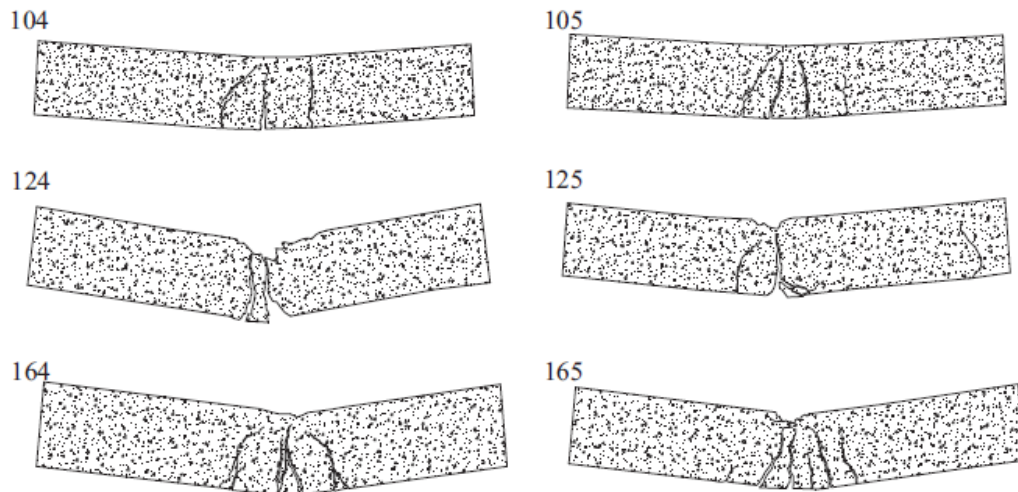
Patrón de propagación de fisuras observado en las vigas encamisadas
